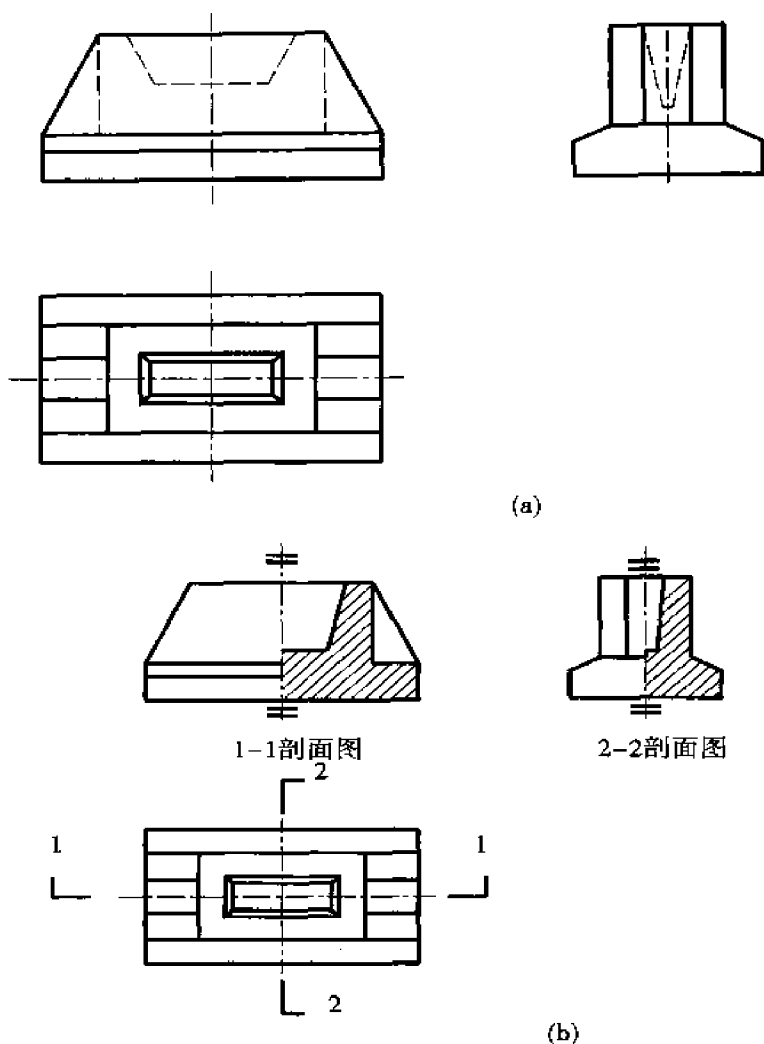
将杯形基础正立面图和左侧立面图改画成半剖面投影
